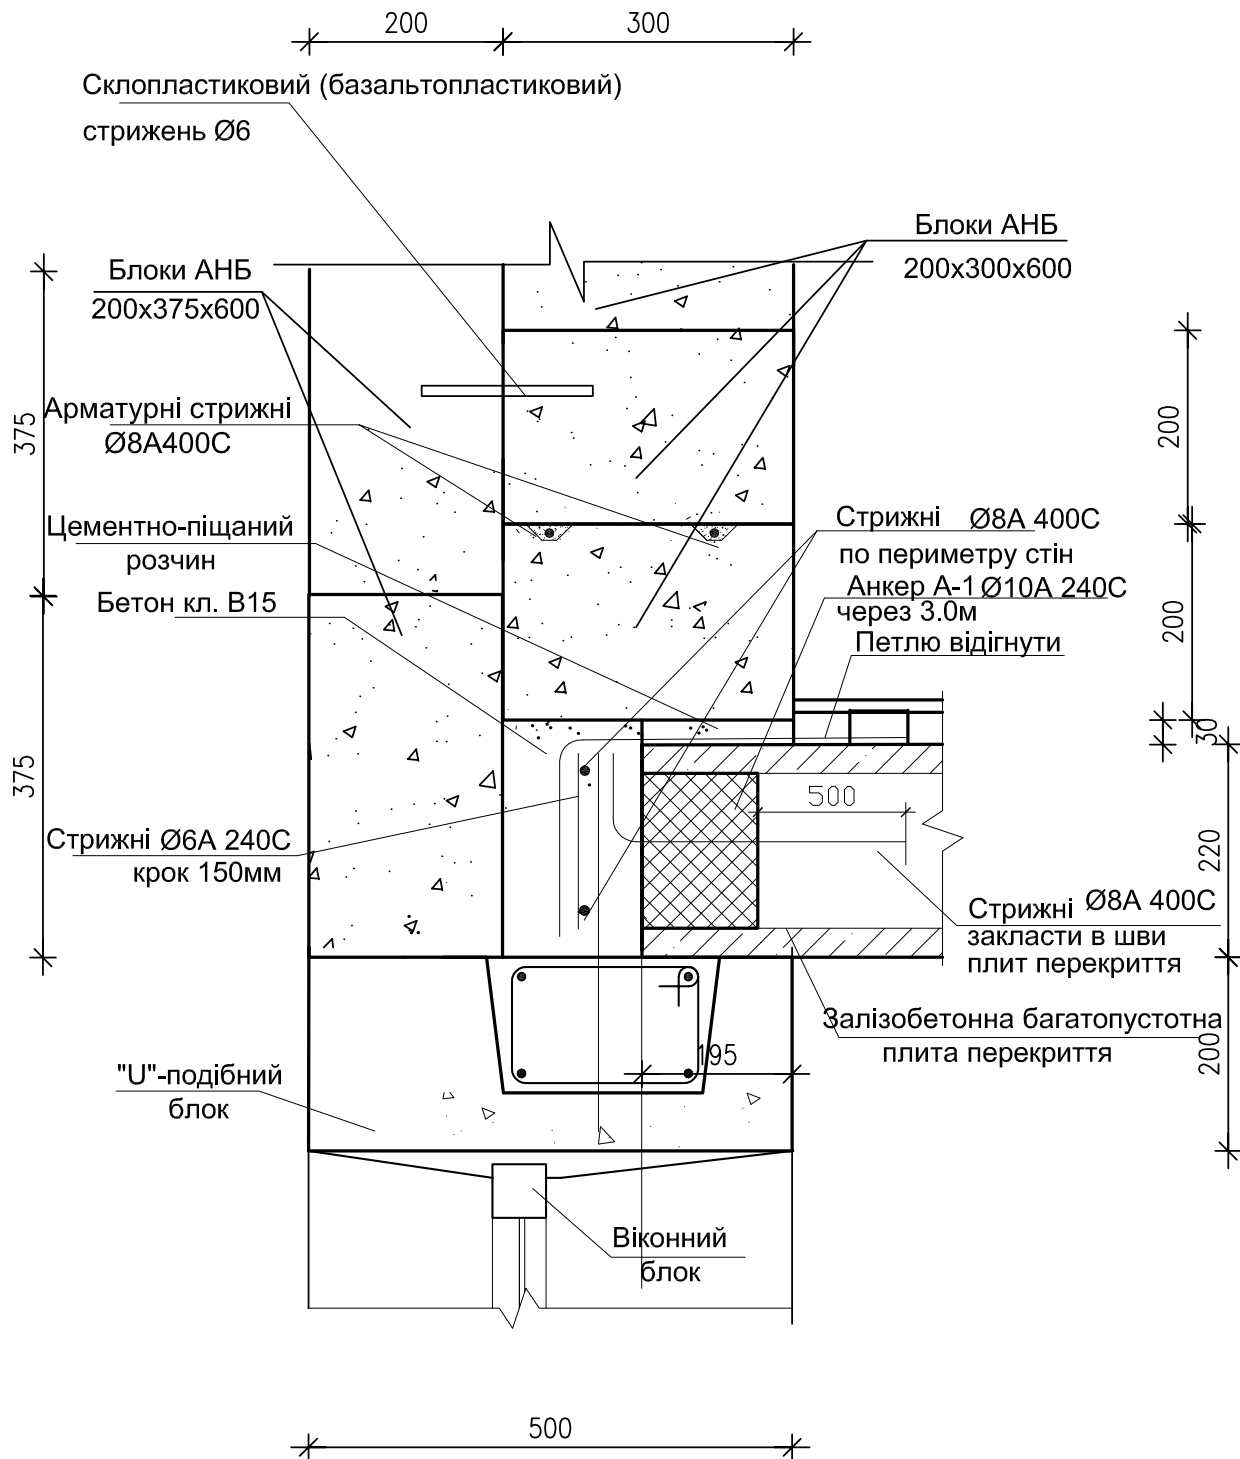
12-1. Двошарова стіна першого типу. Вузол спирання плити перекриття
